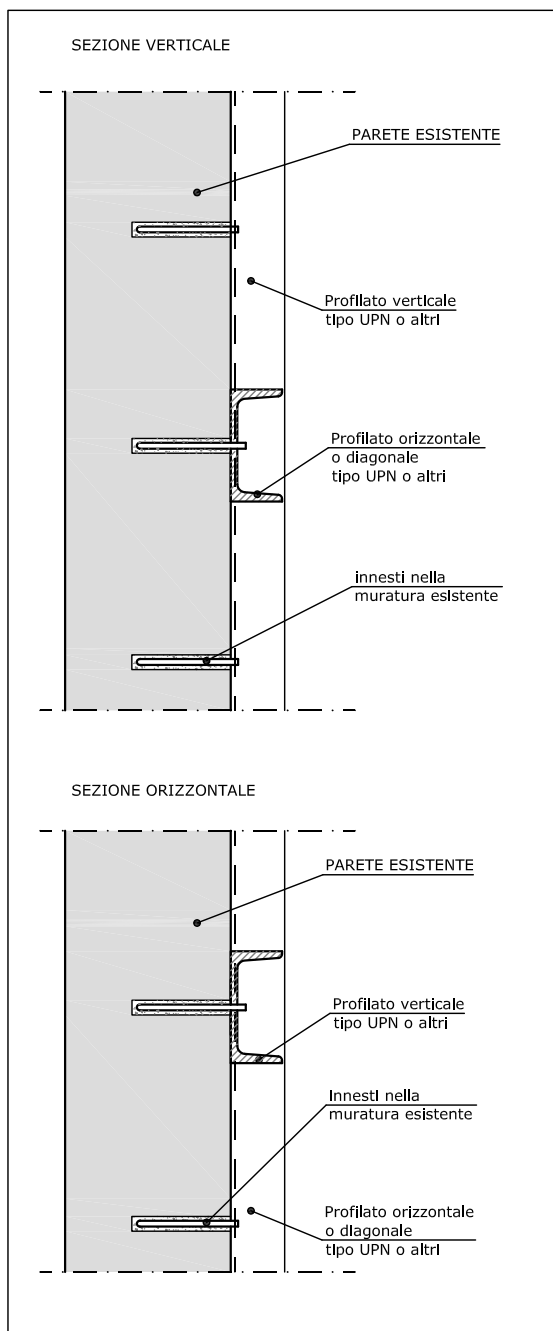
d. Rinforzo parete su di un lato con telaio metallico collaborante esterno di controvento. SEZIONI
